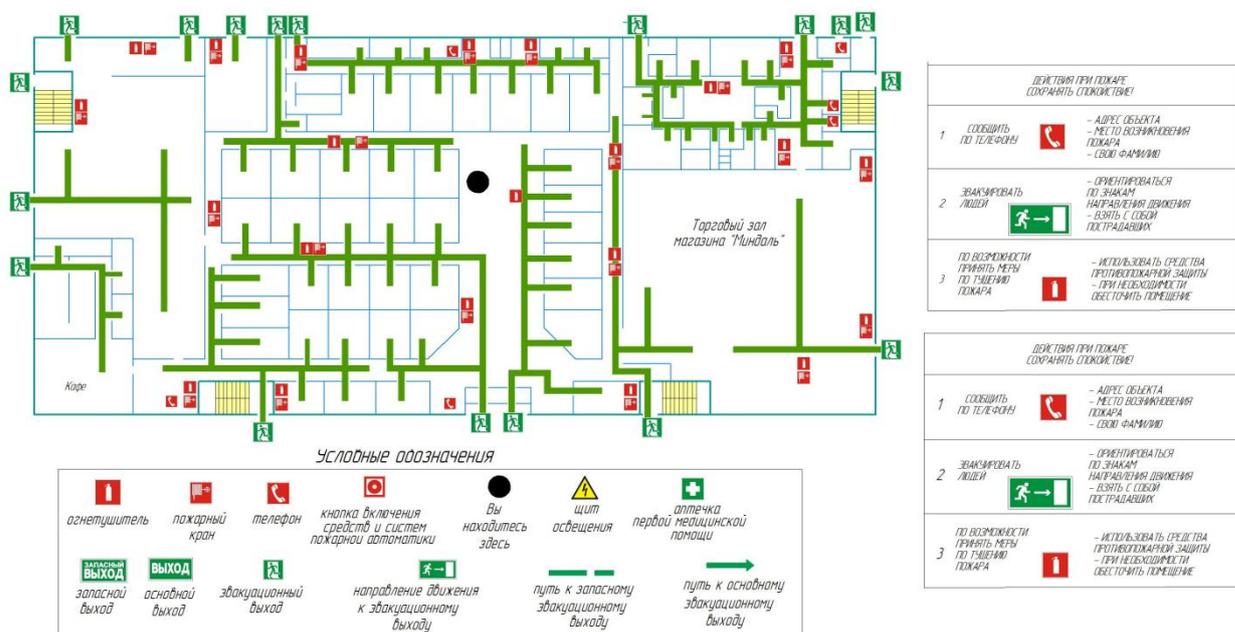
План эвакуации из помещений 1 этажа ТРЦ
